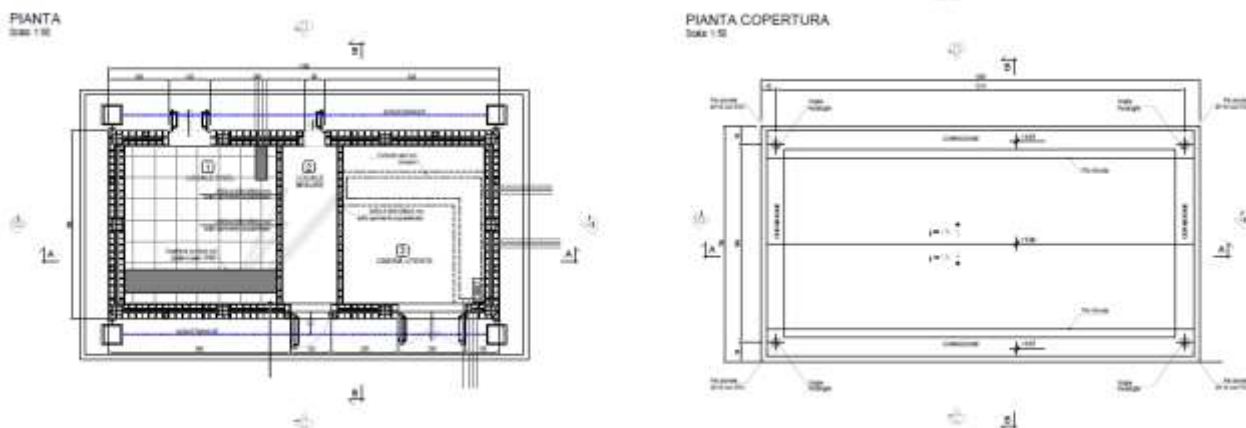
Pianta piano terra (a sinistra) e di copertura (a destra) - Fabbricato FAVU – progetto in variante
